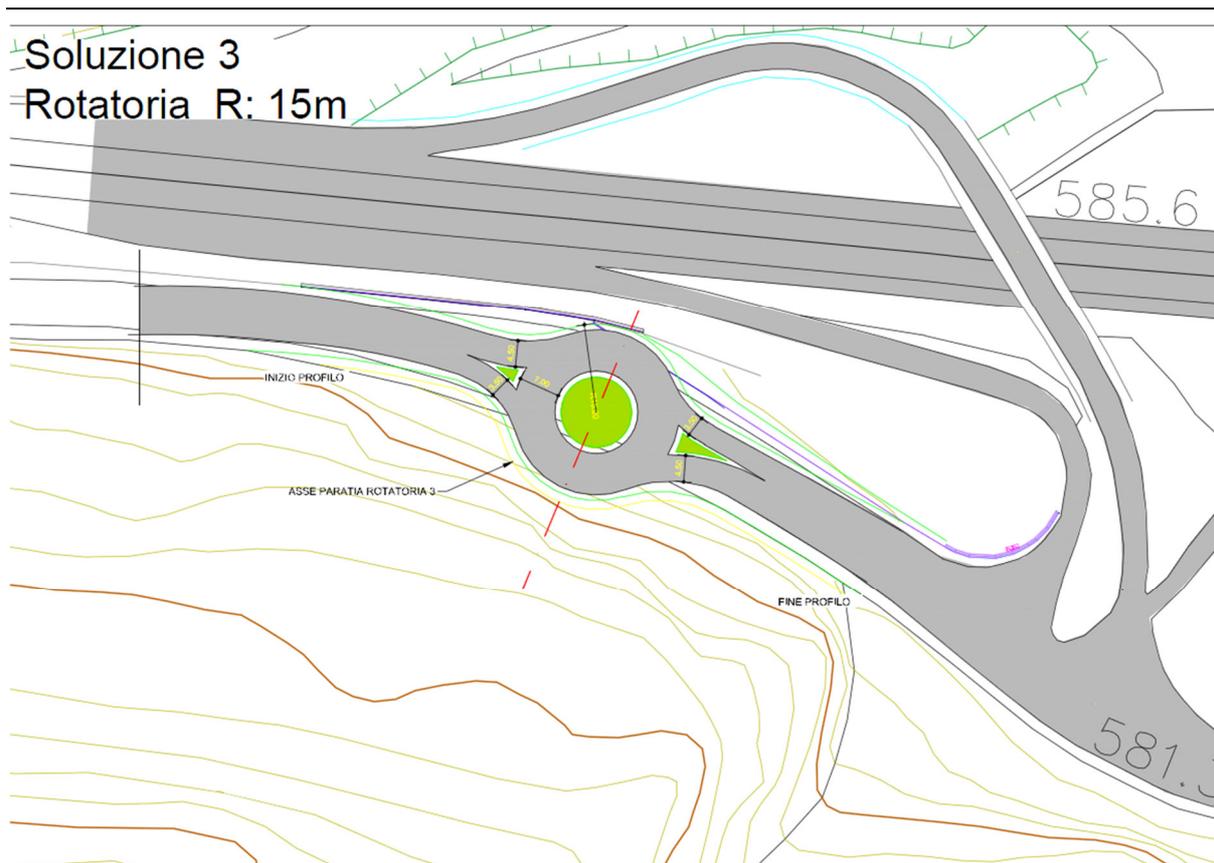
Planimetria Soluzione alternativa n. 3 rotatoria r esterno = 15 m
